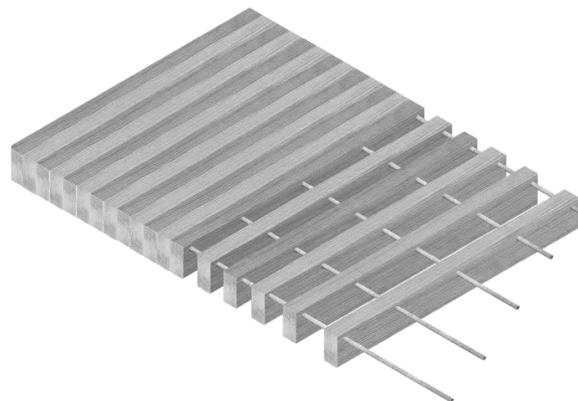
Dowel-Laminated Timber (DLT). (ThinkWood & WoodWorks, 2021).
